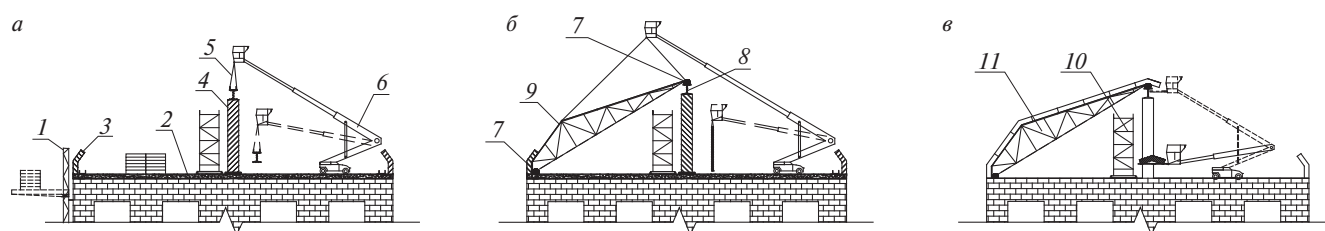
Поэтапная схема монтажа мансарды из сэндвич-панелей: а – установка угловых панелей, ригелей, колонн и направляющих; б – установка монтажной фермы-шаблона; в – установка панелей в проектное положение; 1 – приставной подъемник; 2 – бетонный пояс; 3 – угловая панель; 4 – колонна; 5 – траверсы; 6 – гидравлический подъемник-манипулятор; 7 – направляющие и каток; 8 – ригель (продольная балка); 9 – передвижная ферма-шаблон; 10 – монтажные подмости; 11 – укрупненный блок
